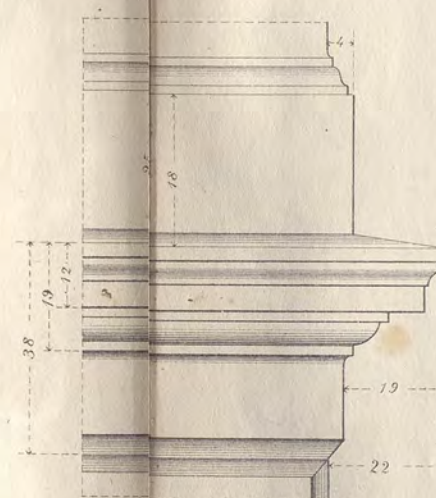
<sup>a</sup> Cimasa del parapetto del 2° piano,
